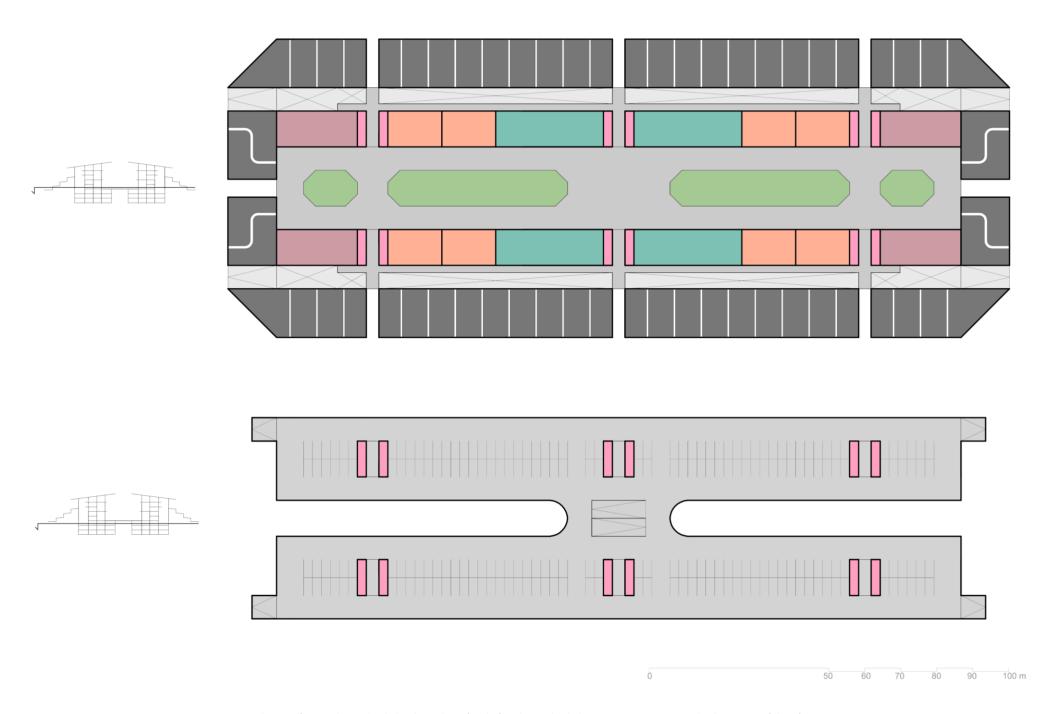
Planta desde la planta baja (arriba) y planta desde los aparcamientos situados bajo tierra (abajo)
